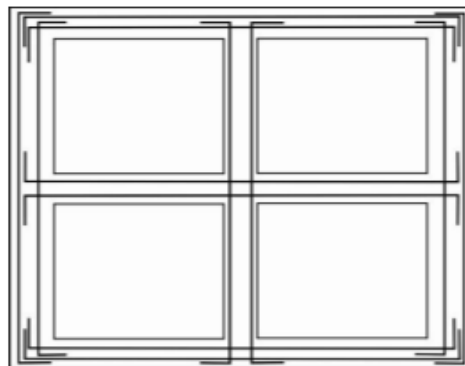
Figura E.2.1-2 Ganchos de anclaje en vigas de cimentación transversales (NSR-10)
